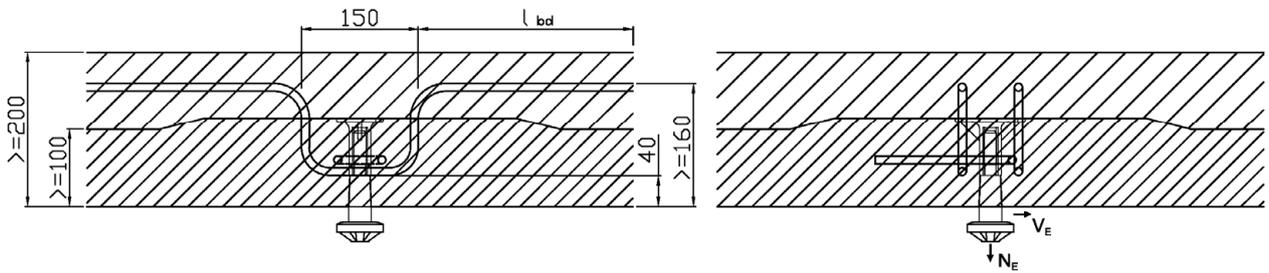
Einbauzustand im Fertigteil mit Ortbetonergänzung
